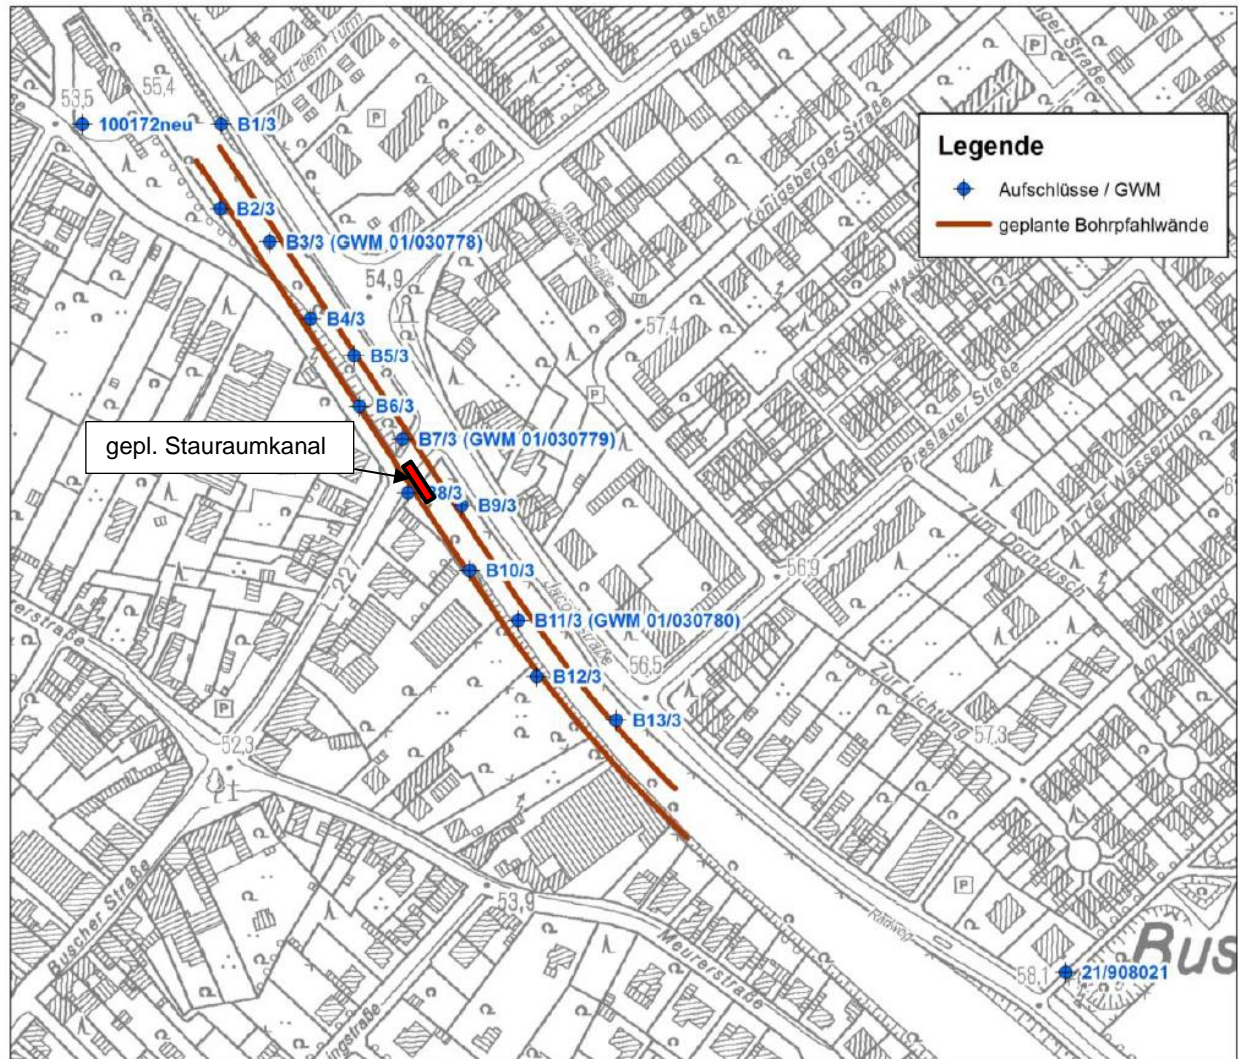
Lageplan mit Bodenaufschlüssen (aus /L3/, ohne Maßstab)
